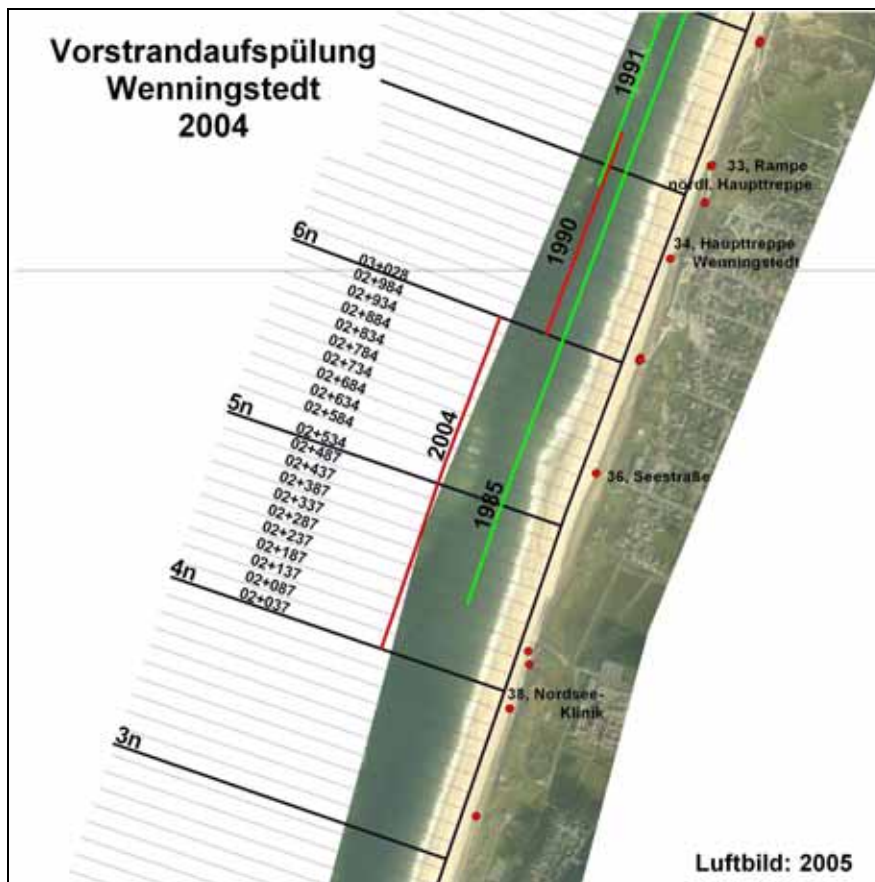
Lageplan Vorstrandaufspülung Wenningstedt 2004
